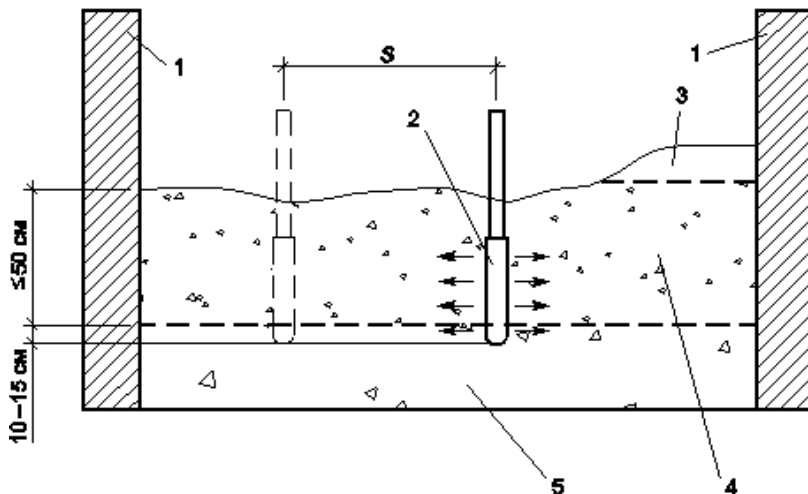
Схема послойного уплотнения бетонной смеси в опалубке:
